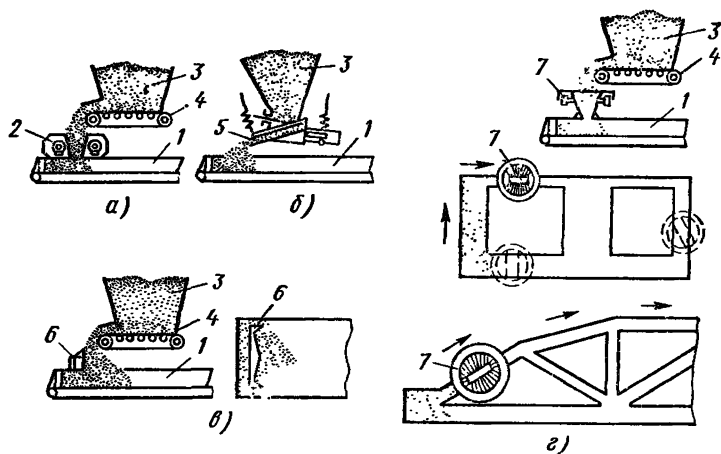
Схема укладки бетонной смеси бетоноукладчиками с различными распределяющими устройствами:
